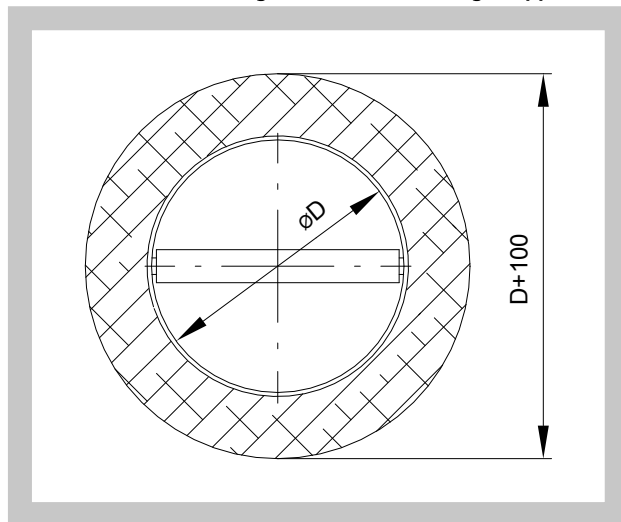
Bauöffnung - runde Entrauchungsklappe
